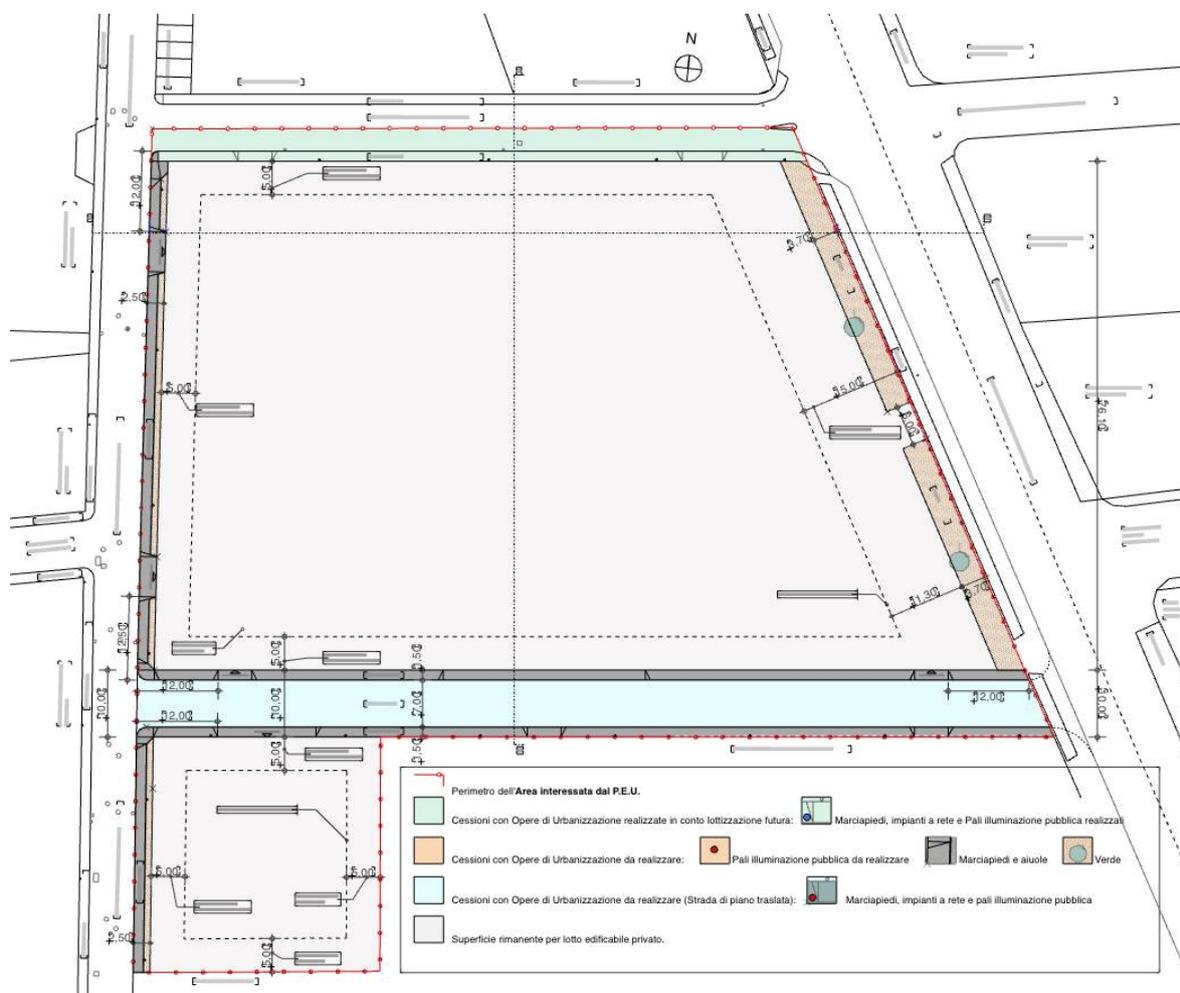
Planimetria generale con individuazione delle nuove conformazioni dei suoli
